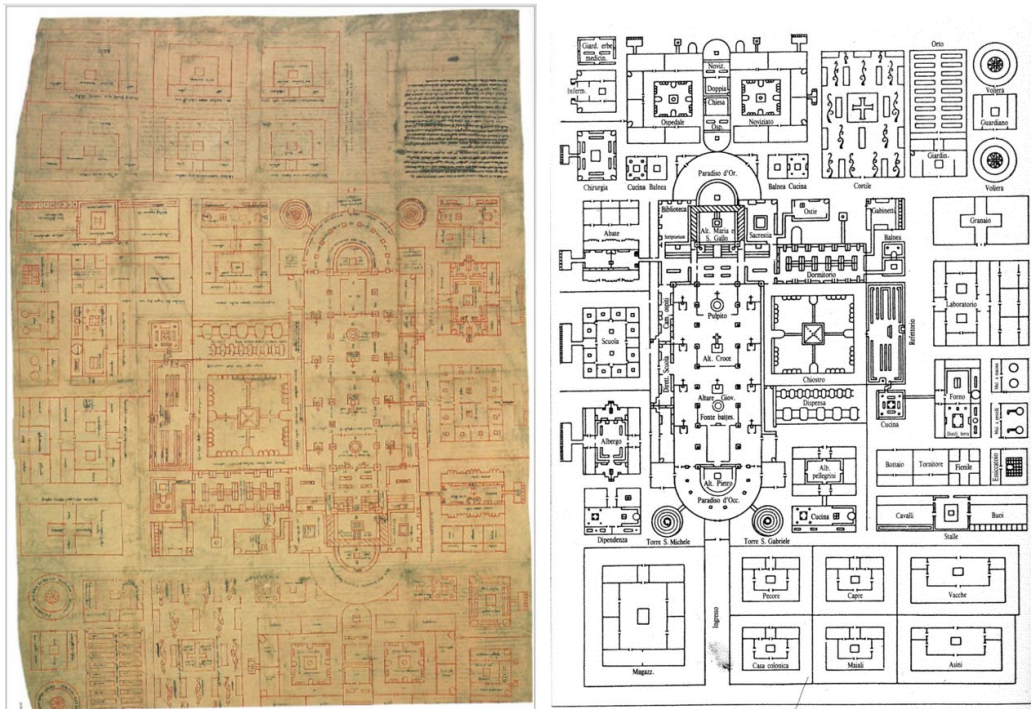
Planimetria dell'abbazia di san Gallo e il suo ridisegno
